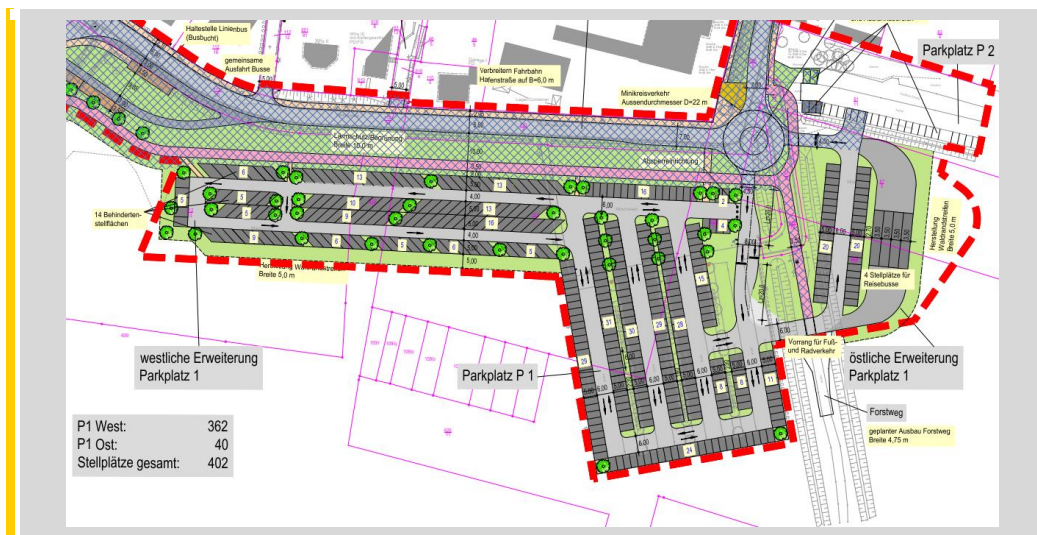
Ausschnitt Lageplan ebenerdige Parkplatzerweiterung
